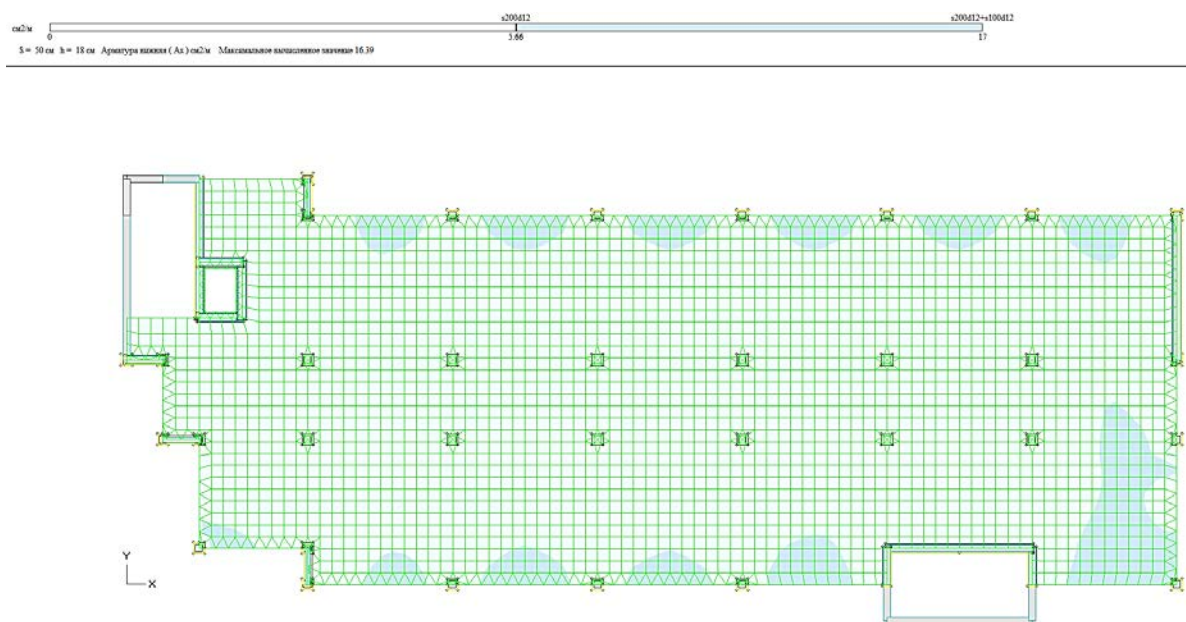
Расчетное нижнее армирование по оси X
